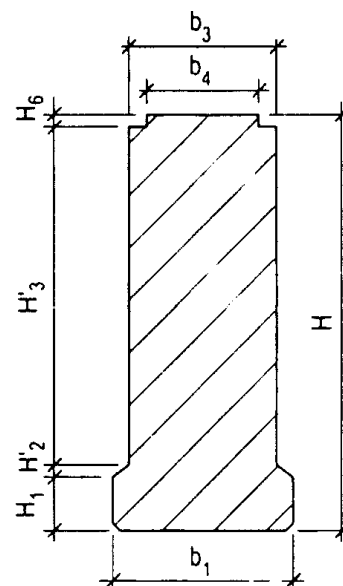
Mặt cắt ngang kết cấu nhịp
